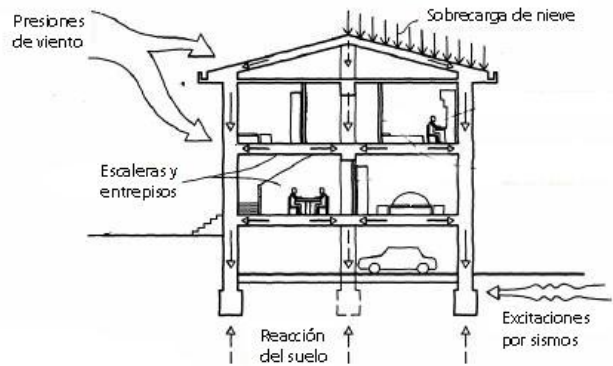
Cargas dinámicas sobre las estructuras (http://medlibrary.org/medwiki/Building_science)
